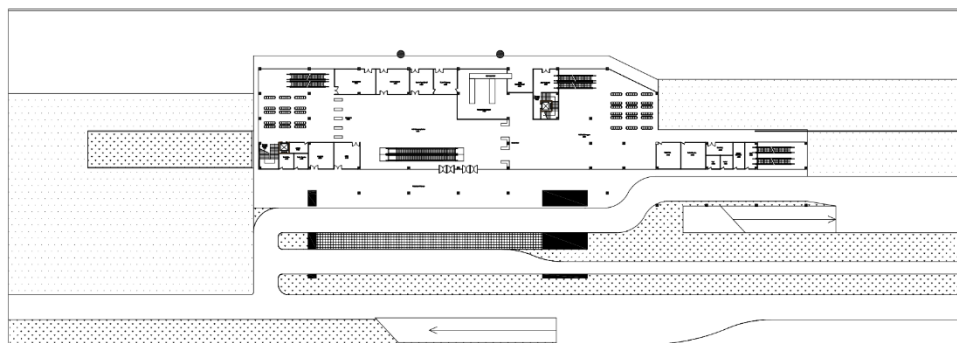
Potongan Bangunan Terminal Penumpang
